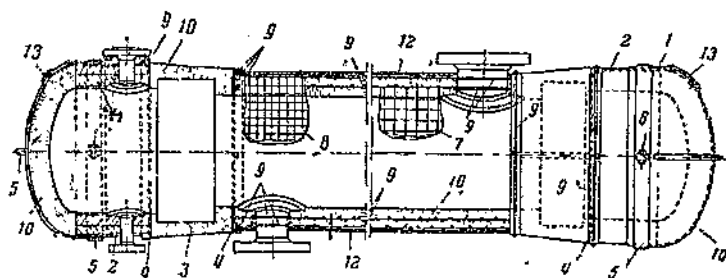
Изоляция теплообменника: 1, 2, 3 — кожух из двух половинок; 4 — манжет; 5 — стяжной пояс; 6 — болты; 7, 8 — каркас; 9 — армирующее кольцо; 10 — засыпная изоляция; 11 — лекальные плиты; 12 — штурвал; 13 — дверка для засыпки изоляции
